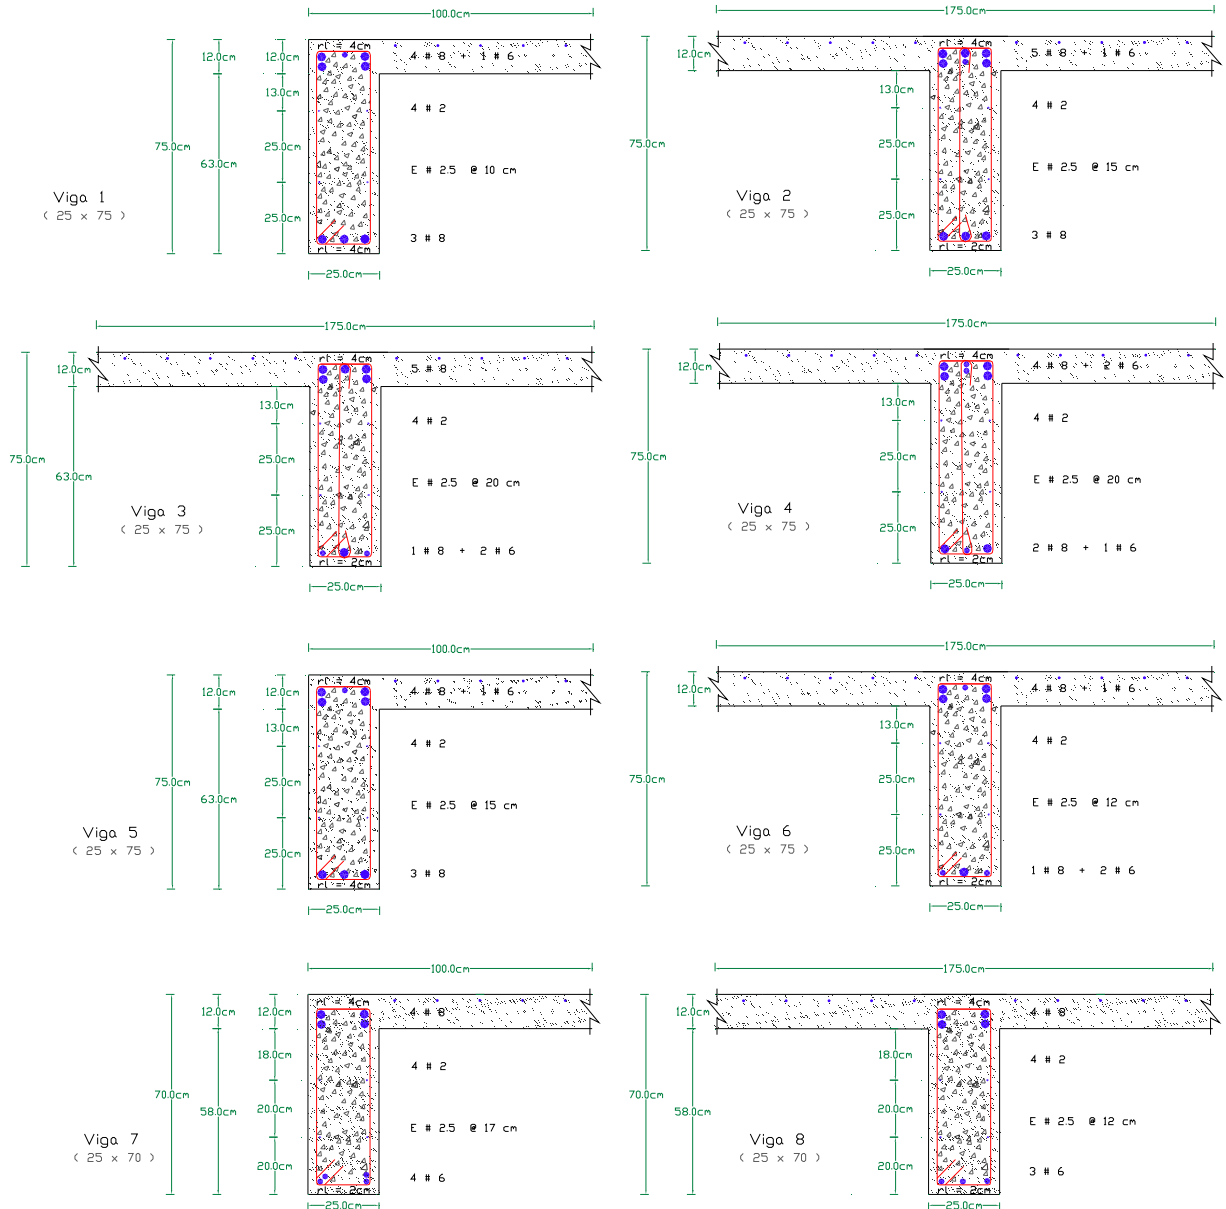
Dimensiones y armado de vigas, edificio I_{15}_I
